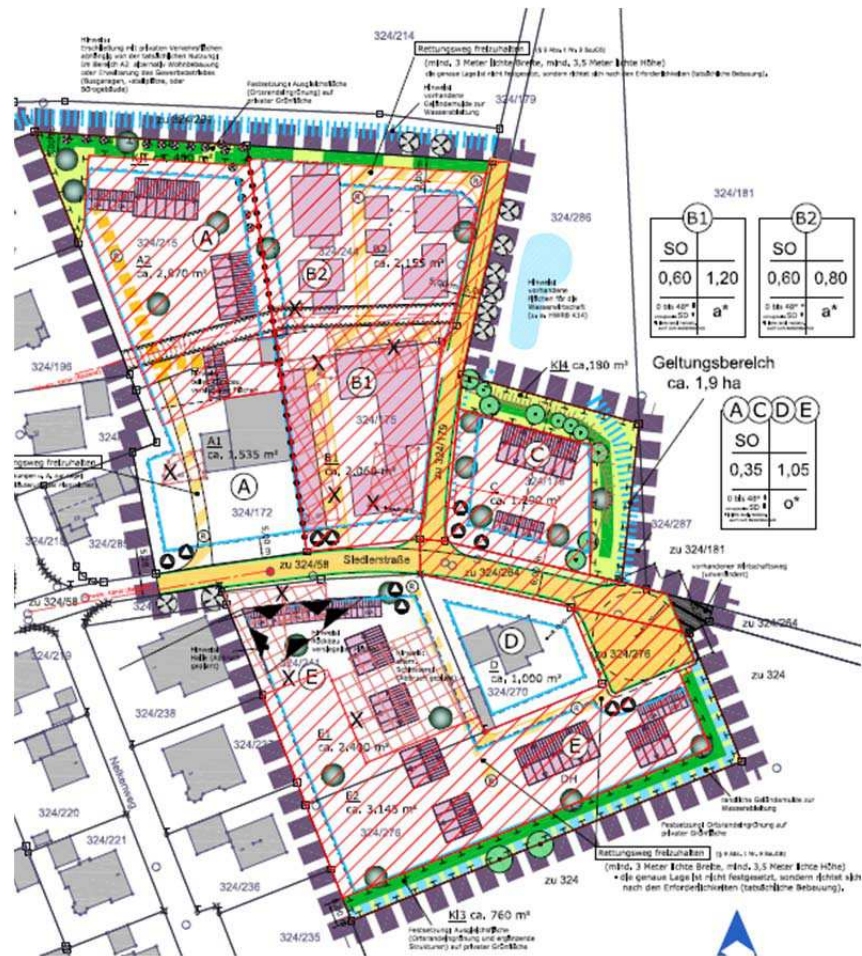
Ausschnitt aus dem geänderten Entwurf mit den Eingriffsflächen
